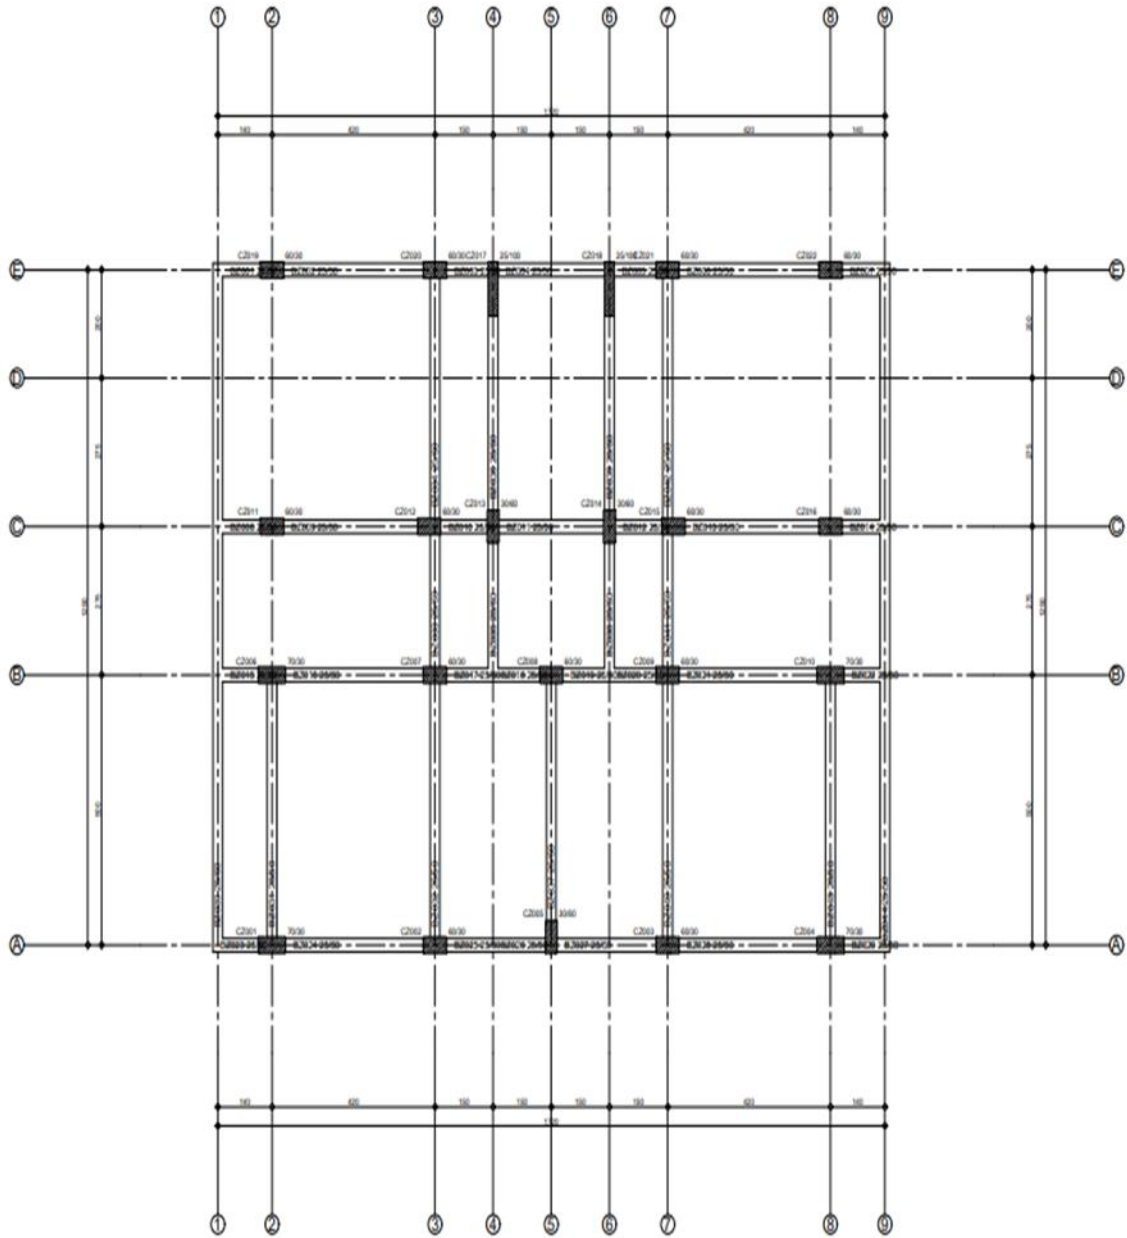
Mehmet Akif Ersoy Tip-2 kat planı.
